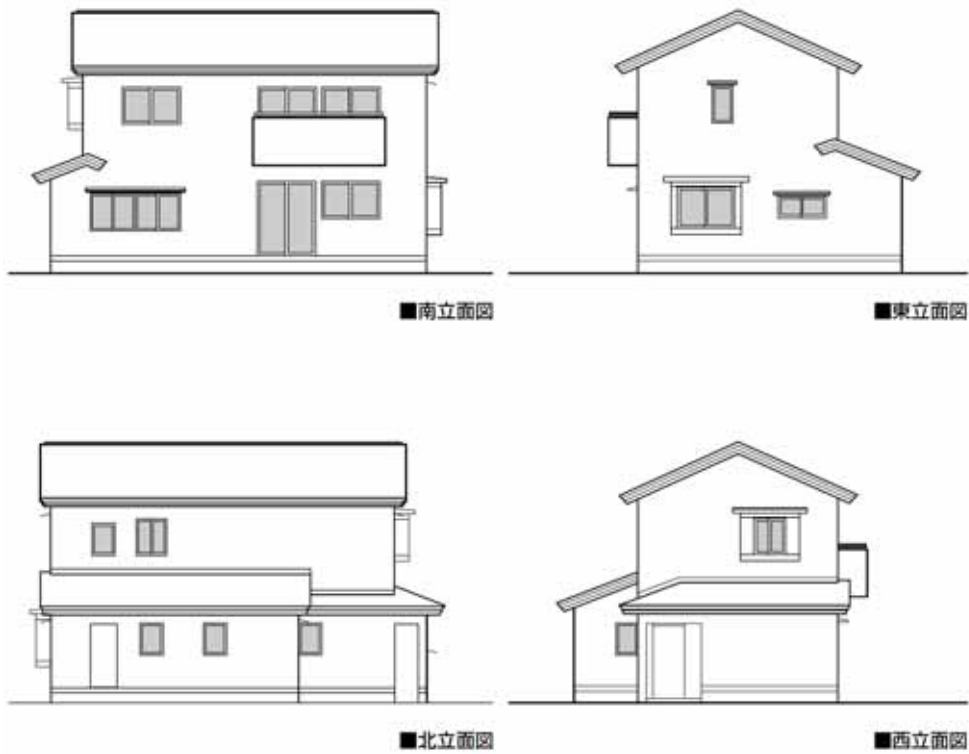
寒冷地用モデルプラン立面図 (a、 b、 地域)
